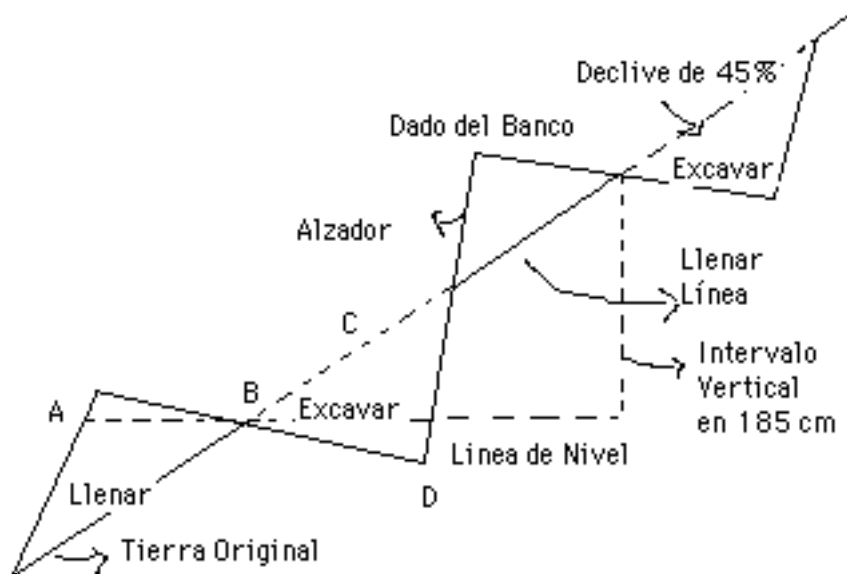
Las terrazas de bancos construídas en tierra con un declive original de 45 %.
